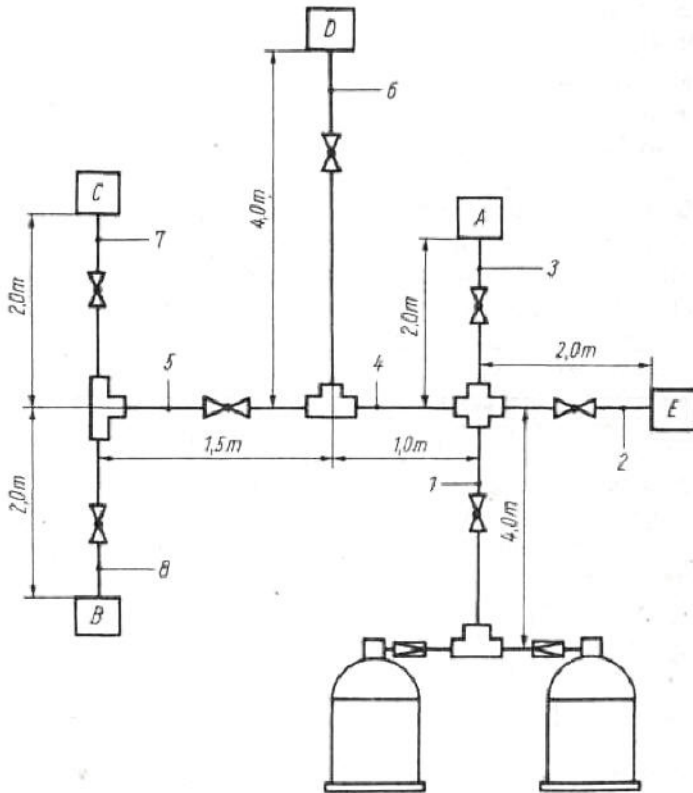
Berechnungsskizze zur Ermittlung der einzelnen Teilstrecken und Widerstände
